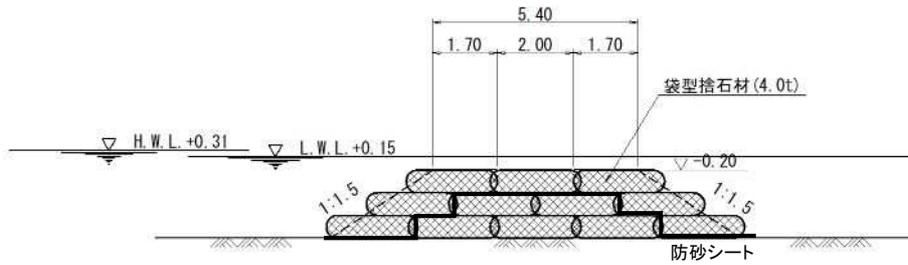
(3) 潜堤本體(暫定時)の標準断面図
